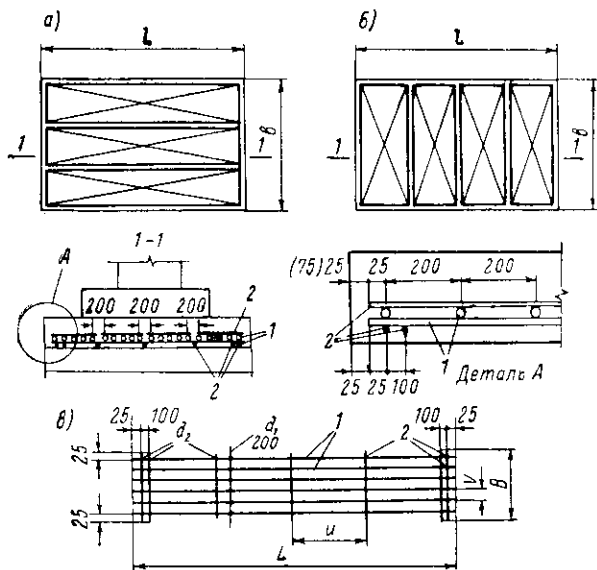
Армирование подошвы фундамента унифицированными сварными сетками
